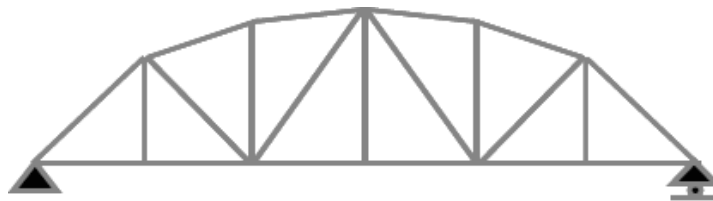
Jembatan Rangka Tipe *Pratt Truss with no Vertical
